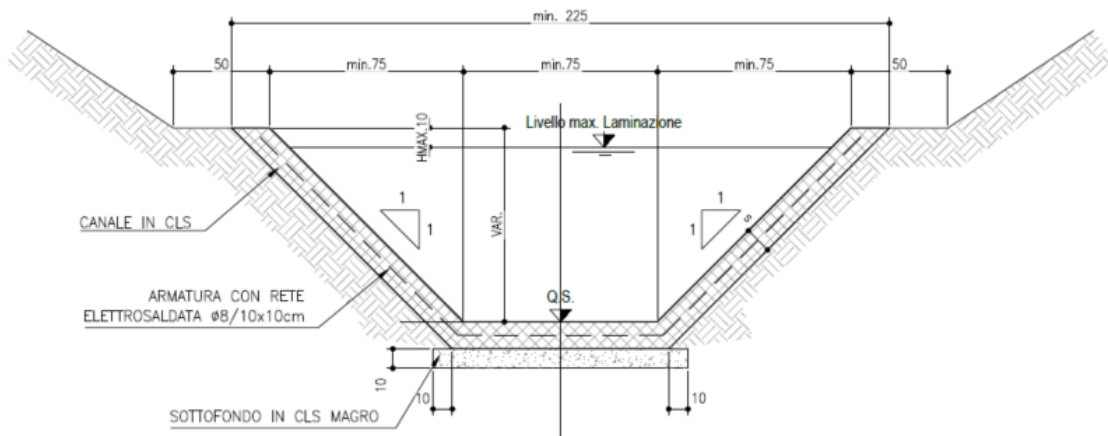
Sezione tipologica dei fossi a sezione trapezia
